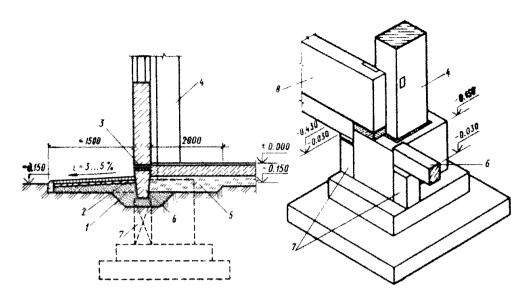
Детали фундаментов крайнего ряда колони:
